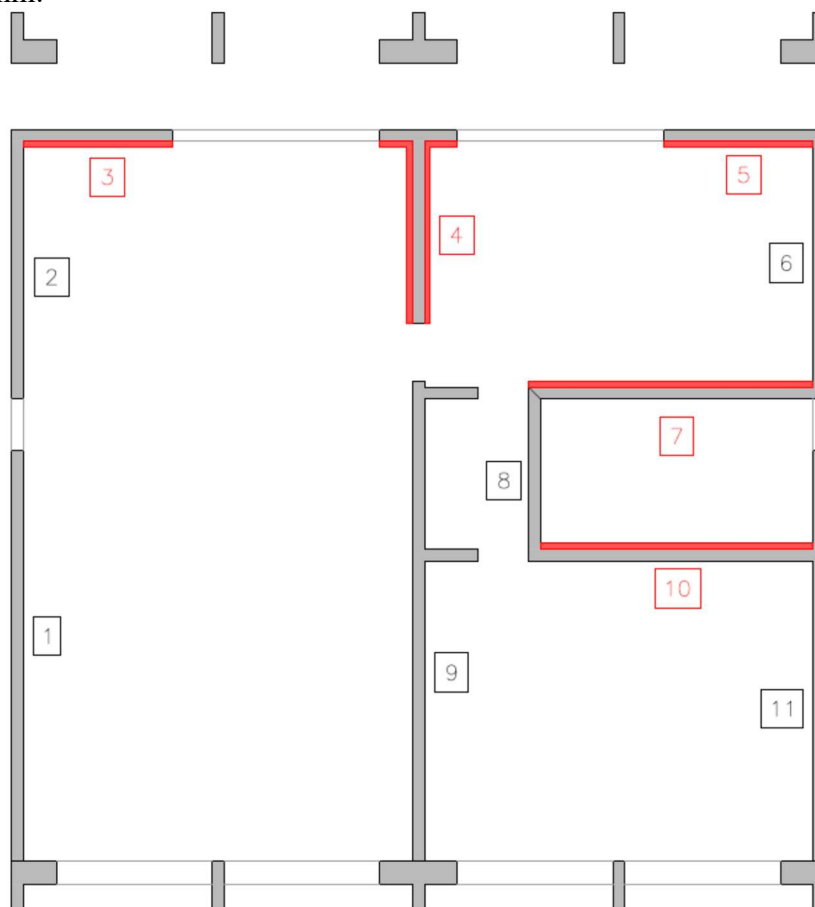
Pianta della casa di guardia con indicazione delle pareti verticali da ingrossare
